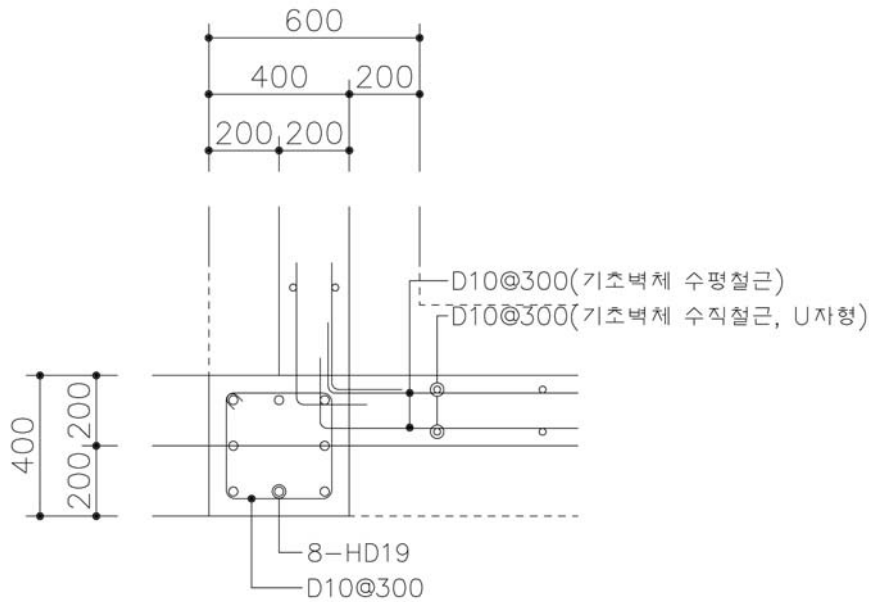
기초구조 평면도 (2-2 세세부 제공)
